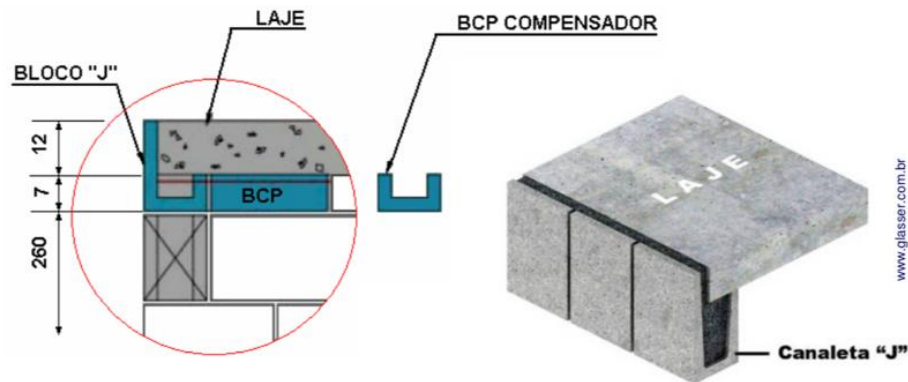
Detalhe da ligação de alvenaria estrutural com a laje
